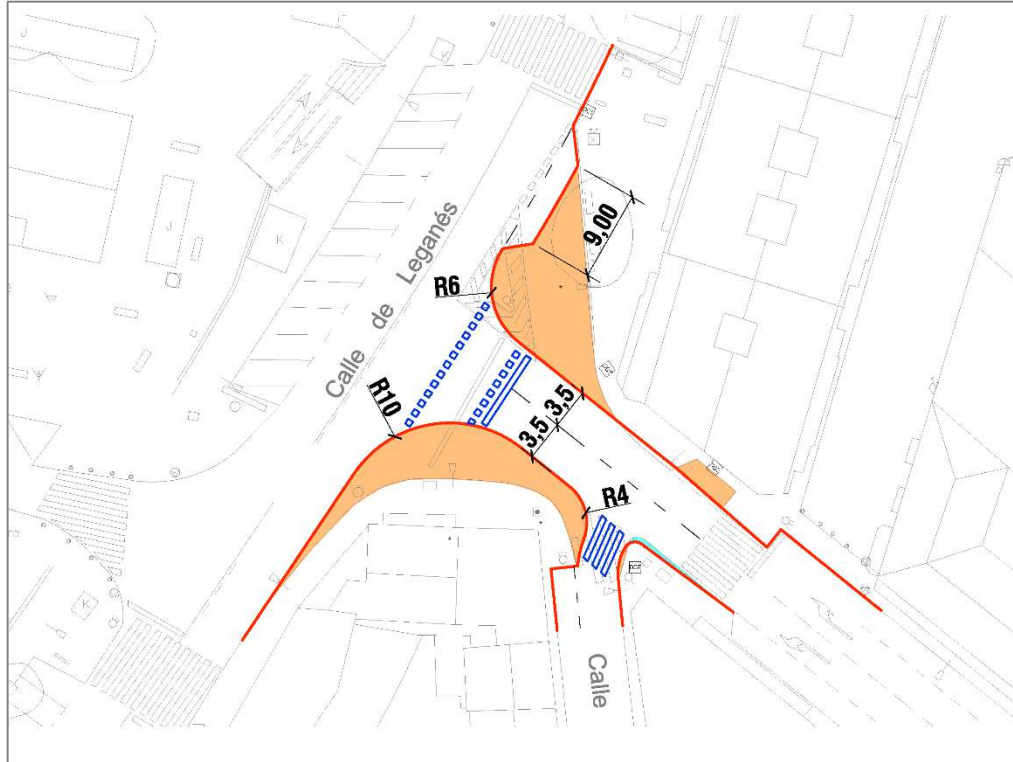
Propuesta actuación en la intersección de la calle Leganés con Av. Fco. J. Sauquillo.
